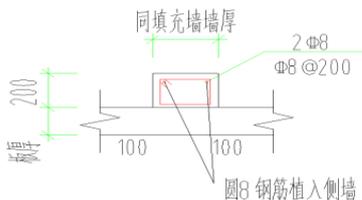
厨房、卫生间墙基混凝土坎台做法示意图
